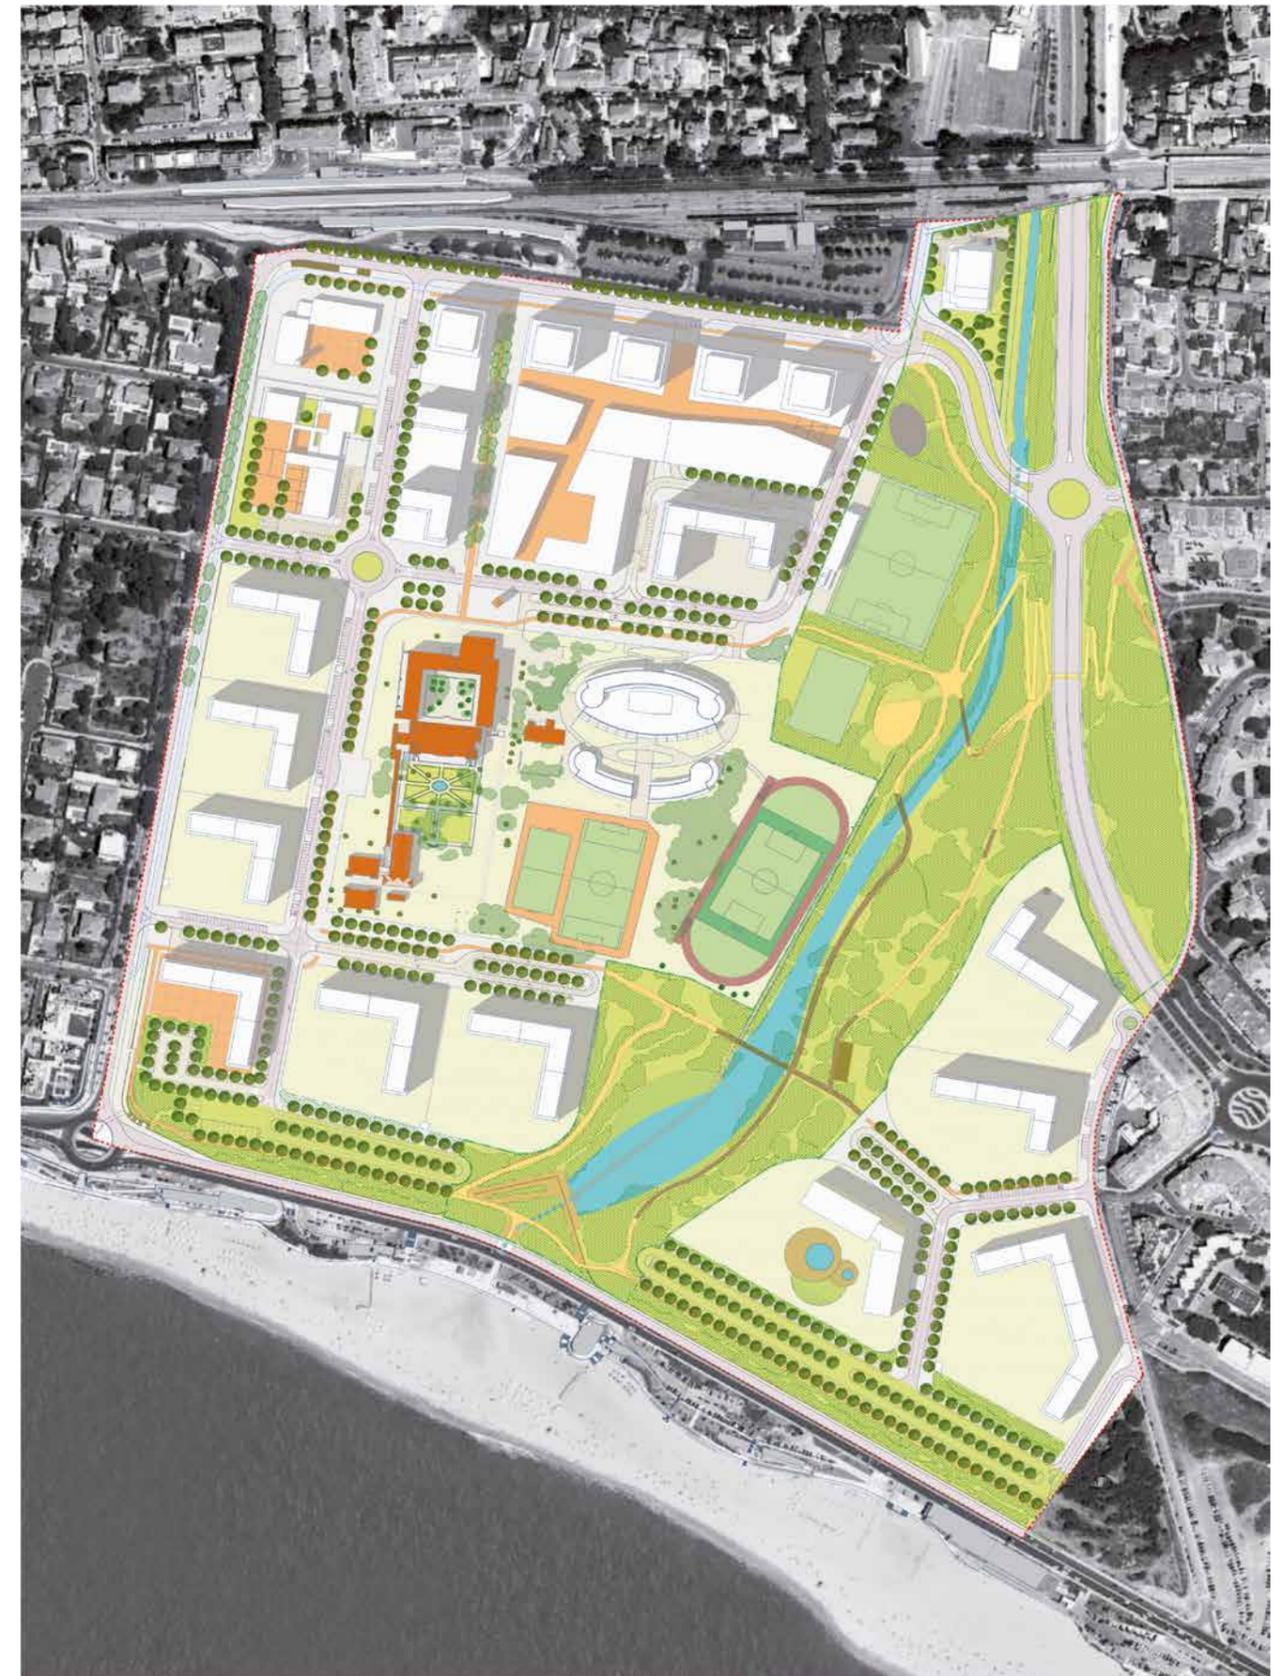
| Planta de apresentação da Proposta Final do PPERUCS
